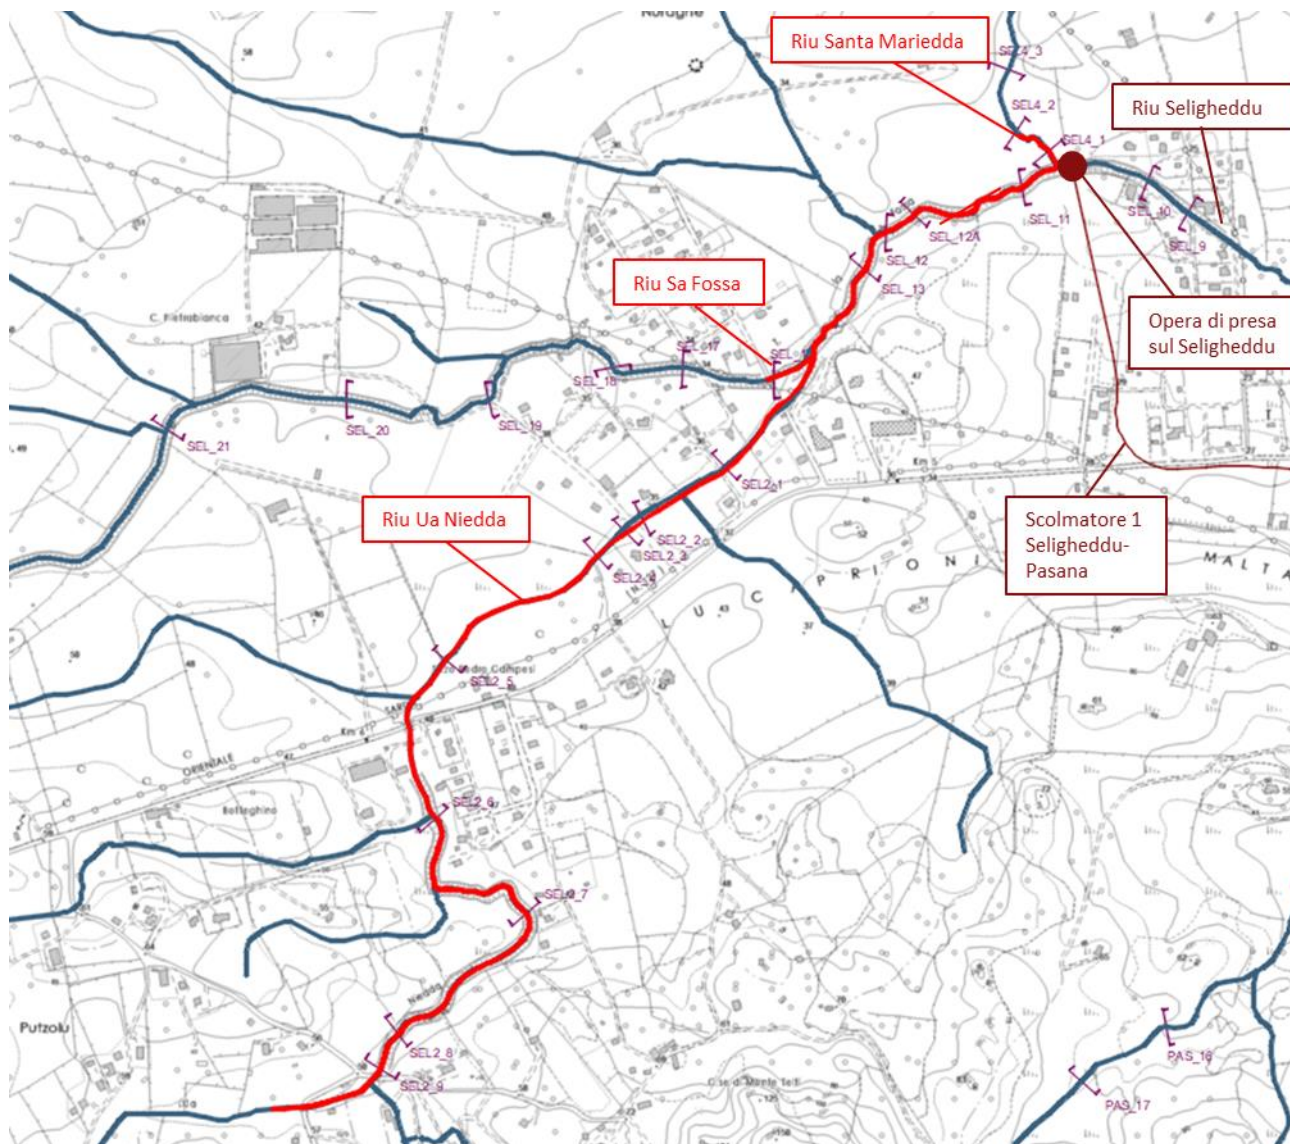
Estratto planimetrico su CTR. In rosso il tratto oggetto di intervento sul riu Ua Niedda.
